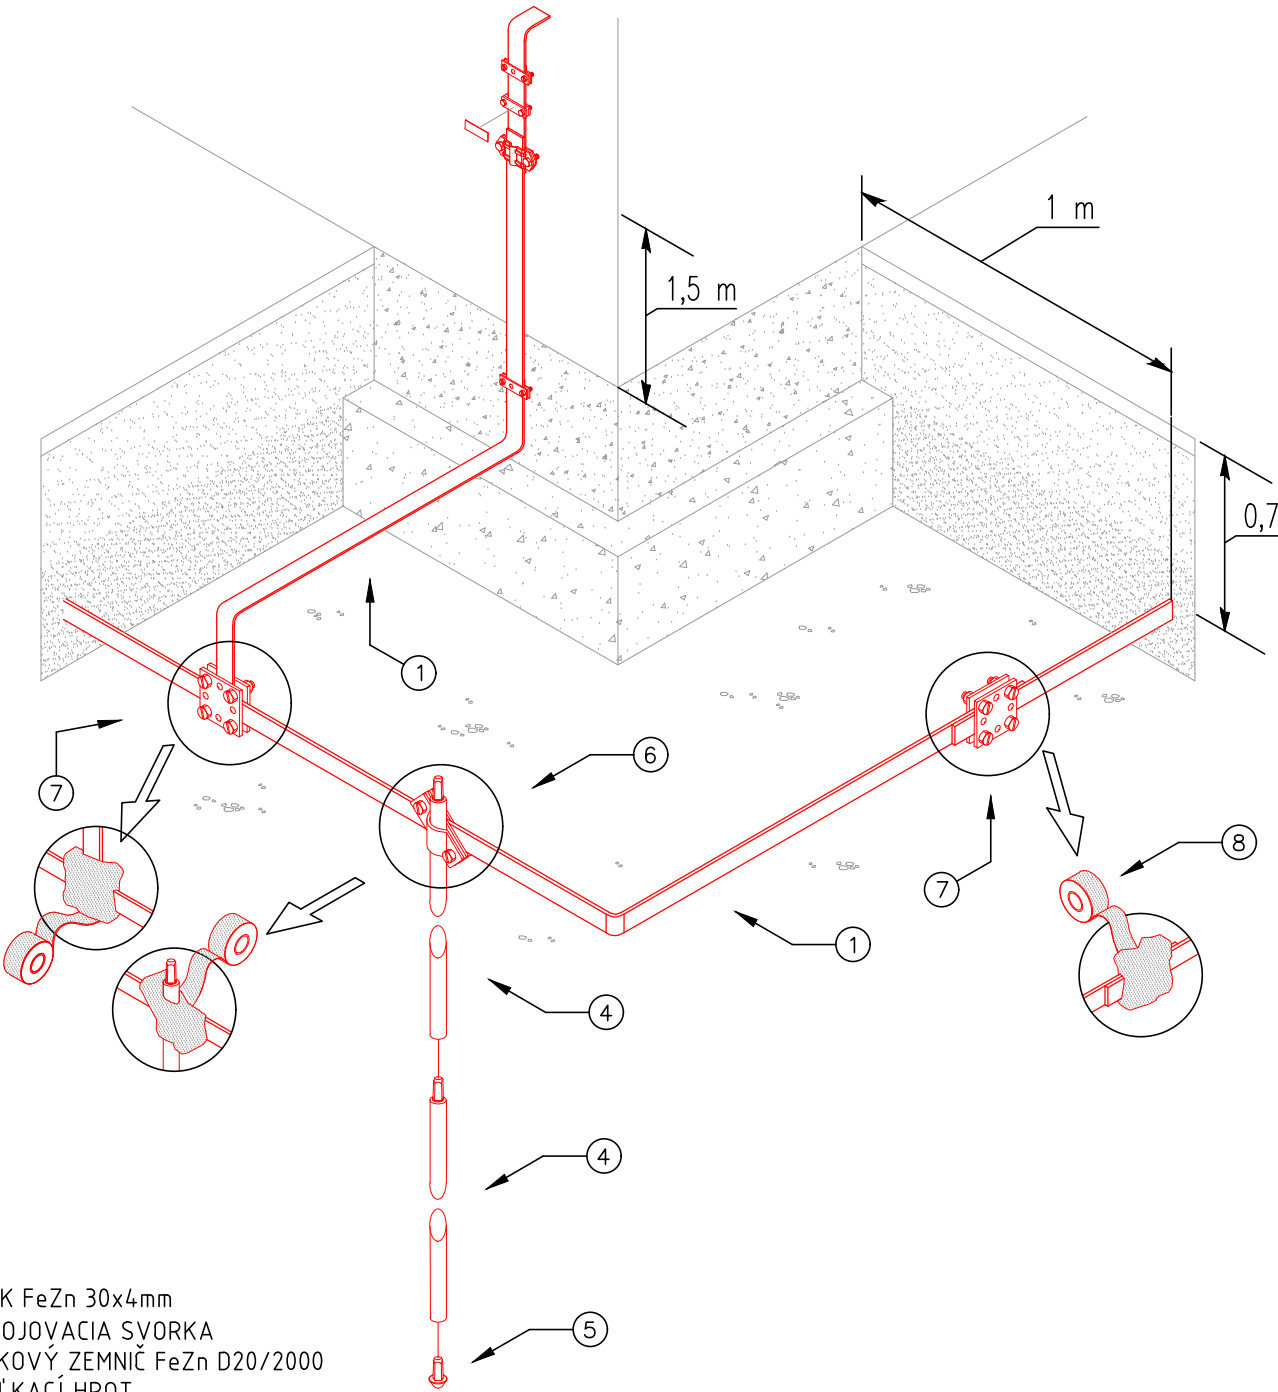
DETAIL ZÁKLADOVÉHO UZEMŇOVAČA
